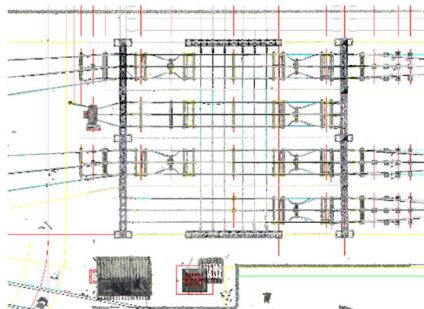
Casa de Reles construída Fora da planta de projeto.
